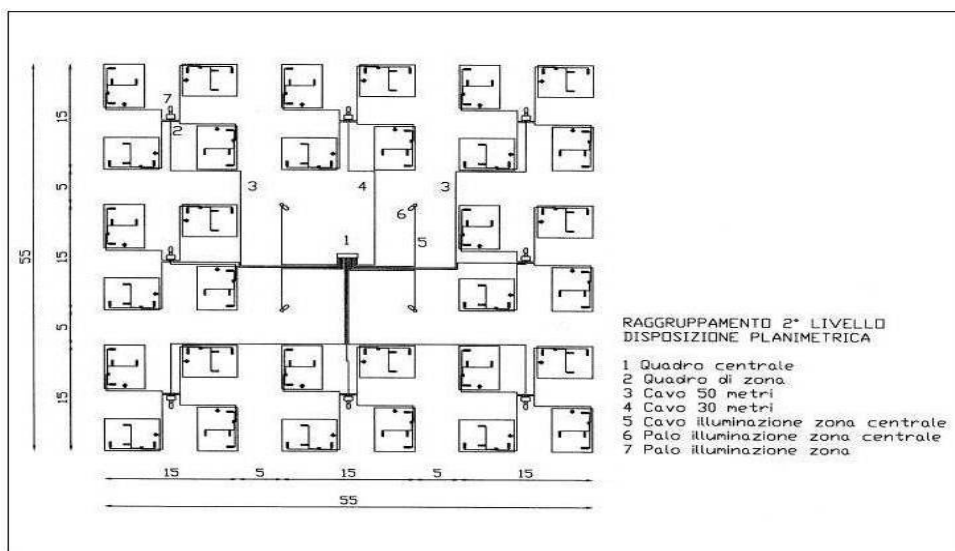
Disposizione planimetrica tipo per raggruppamento di 2° livello
